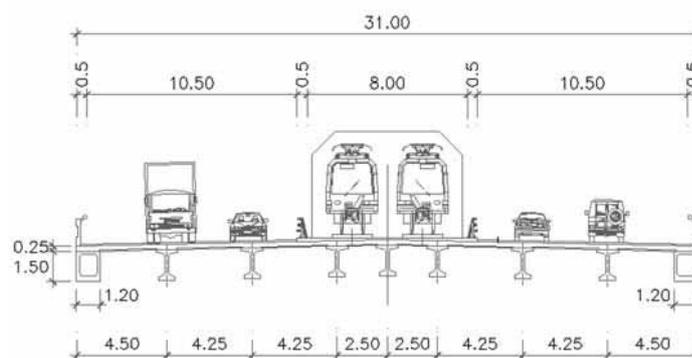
Sección tipo tablero estructura sobre la Isla de Saltés.
